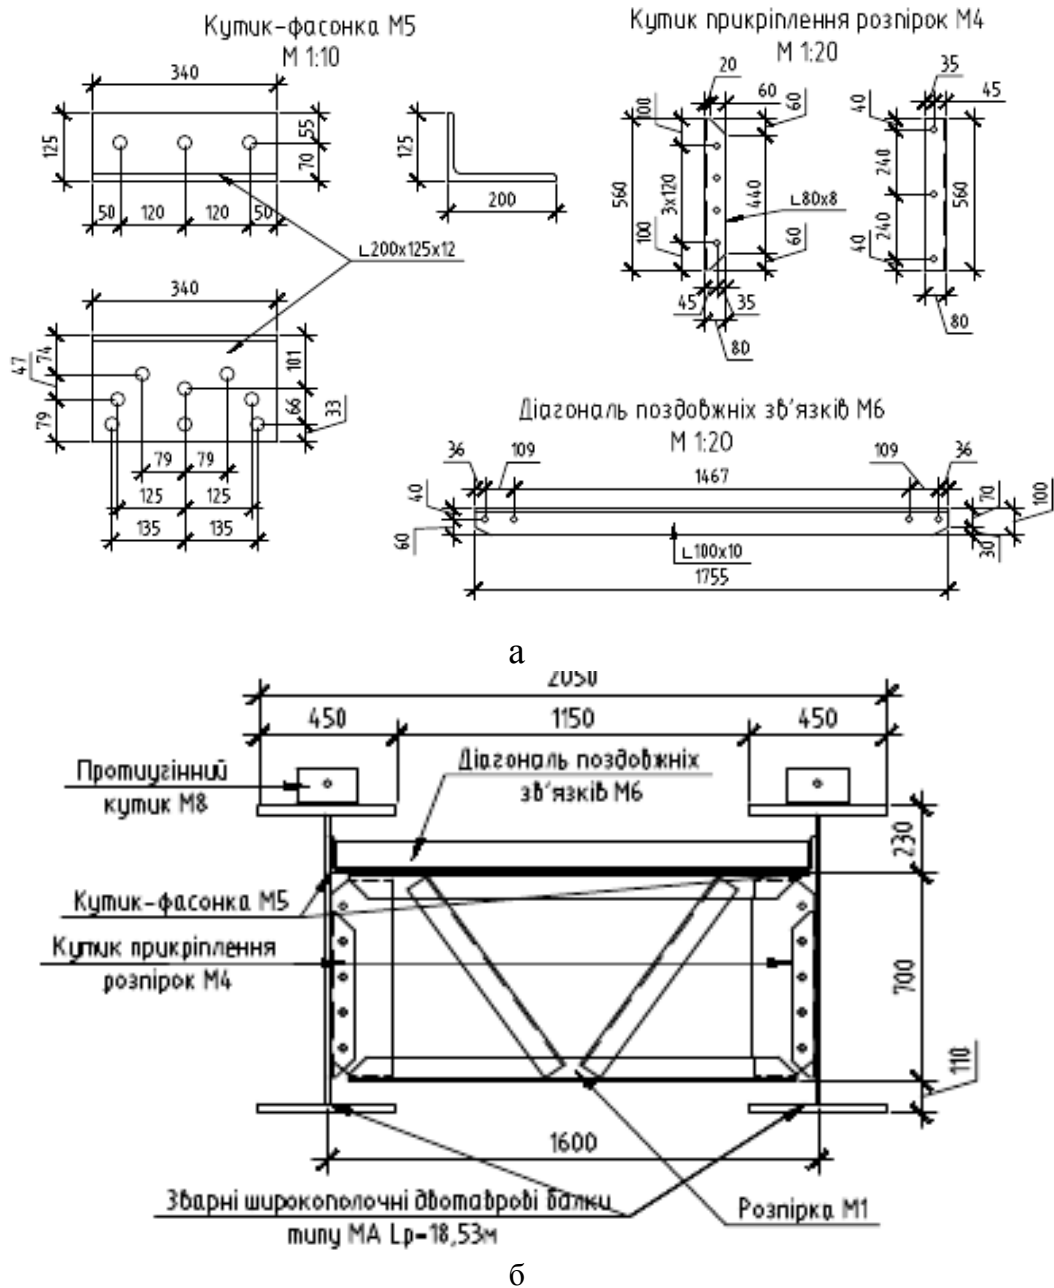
Об'єднання повздовжніми і поперечними зв'язками двотаврових зварних широкополочних балок типу МА:
